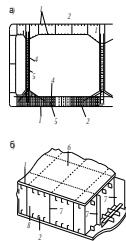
Секція тунелю в м. Кобе: а) поперечний переріз; б) об'ємний фрагмент; 1 – сталева оболонка; 2 – ребра жорсткості; 3 – діафрагма; 4 – арматурний каркас; 5 – стяжка; 6 – комірки; 7 – сталеві пластини, 8 – монолітний бетон.
